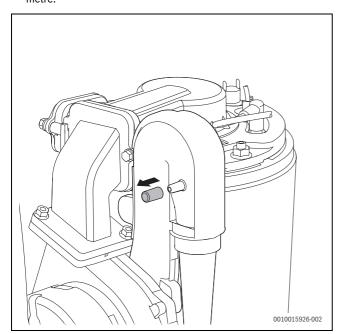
Tubulure de mesure sur le dispositif de mélange
